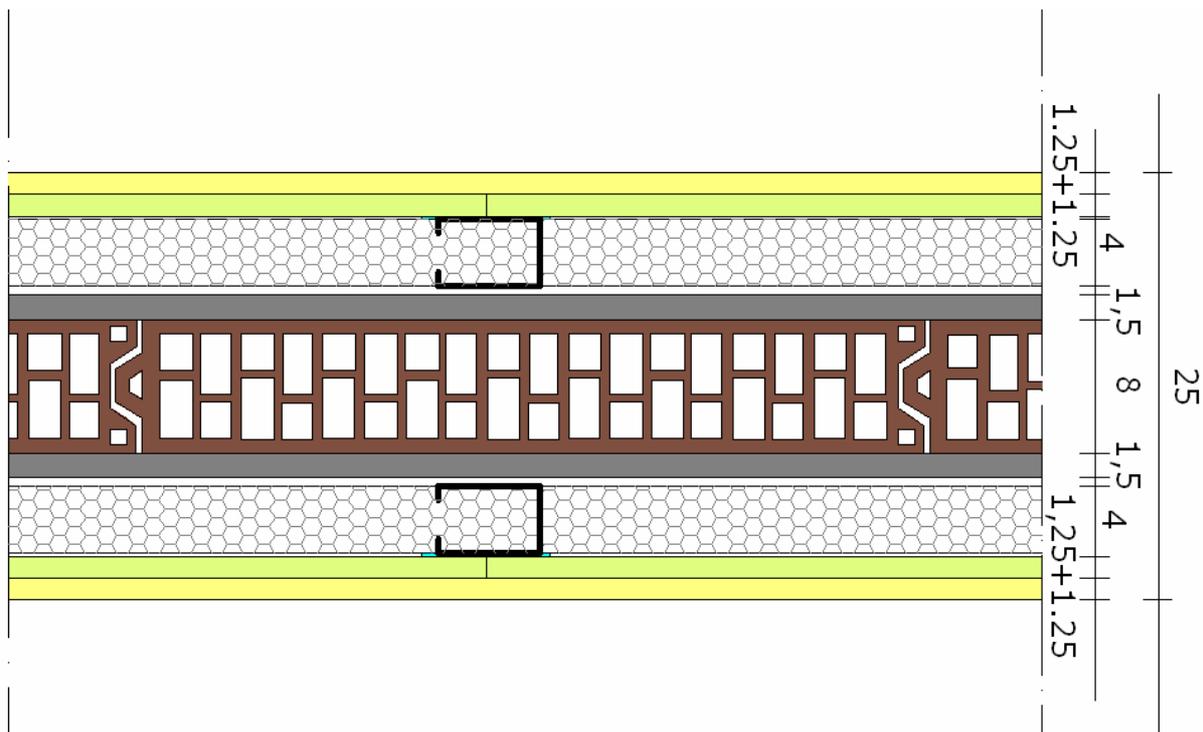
Sezione orizzontale della parete tra camere da letto contrapposte
